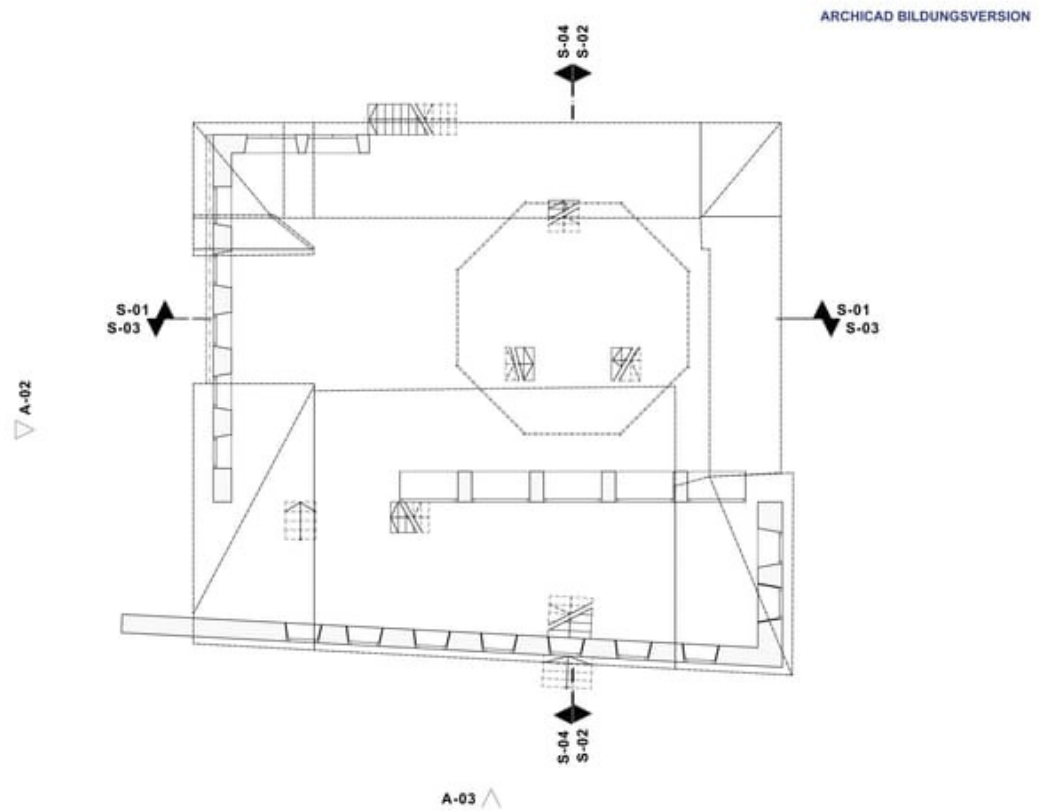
06.01_Grundriss_1OG.pdf
